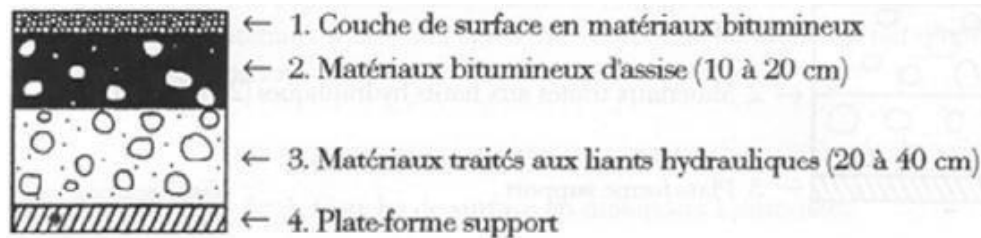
Représentation d'une chaussée à structure mixte [5]
